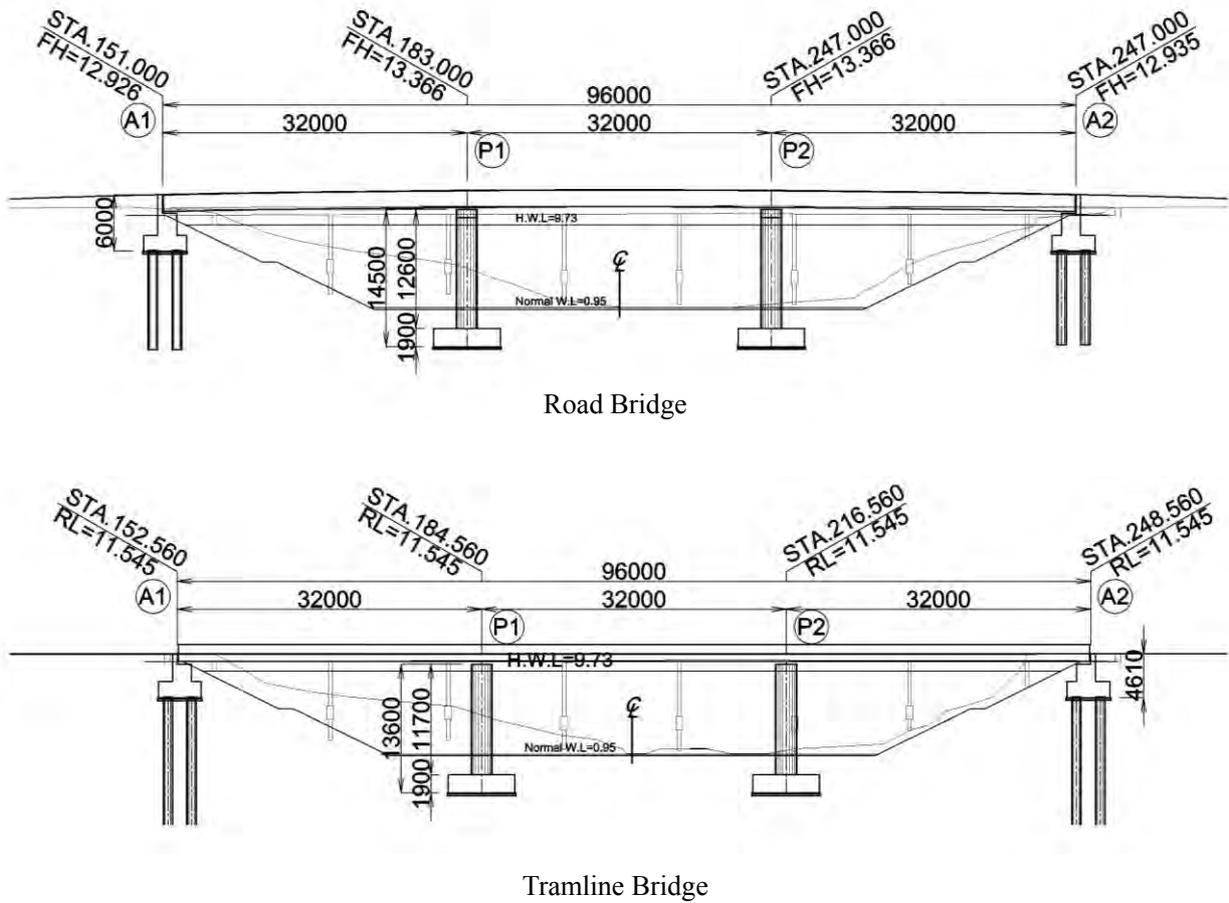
架け替え橋側面図(Old Queens Road Bridge) Source: JICA Study Team
